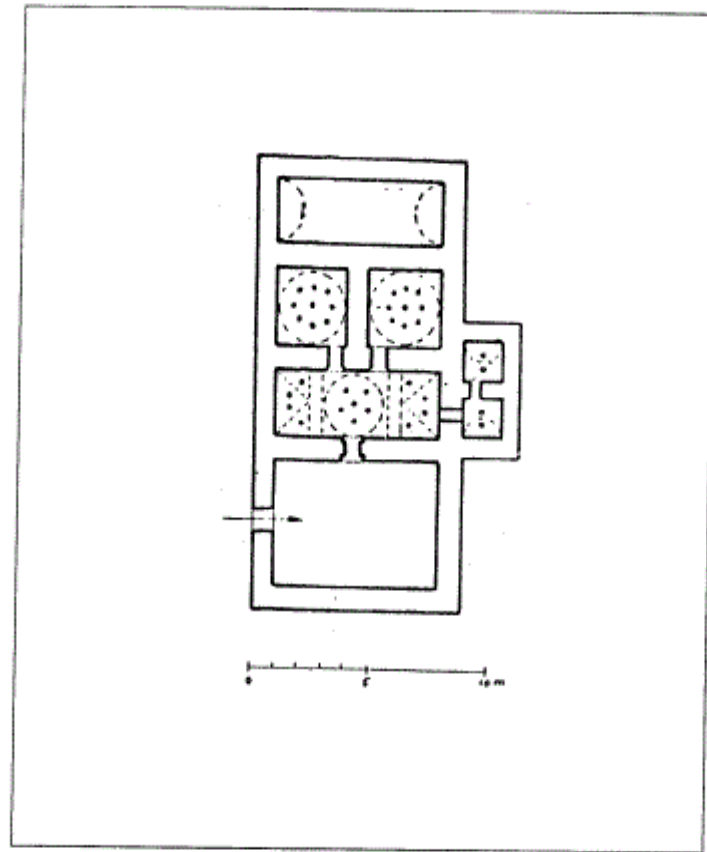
مسقط أفقي حمام خادم علي باشا في نوفا زاجورا بيلغاريا (عن : كيل) .
